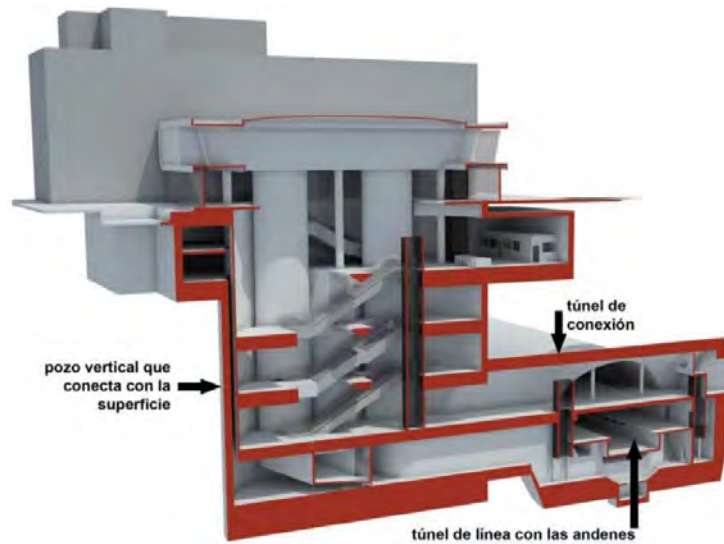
Estación excavada en Caverna tipo 1. Fuente: Proinversión.
